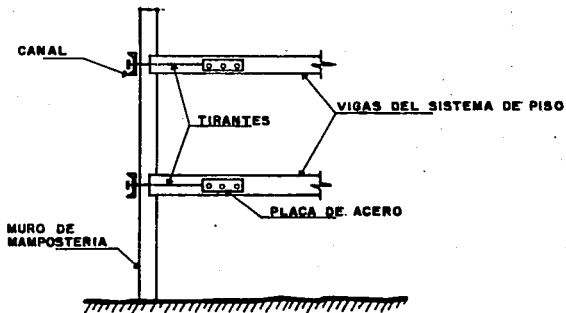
Anclaje de muro exterior a vigas de los sistemas de piso (Ref. 15)
